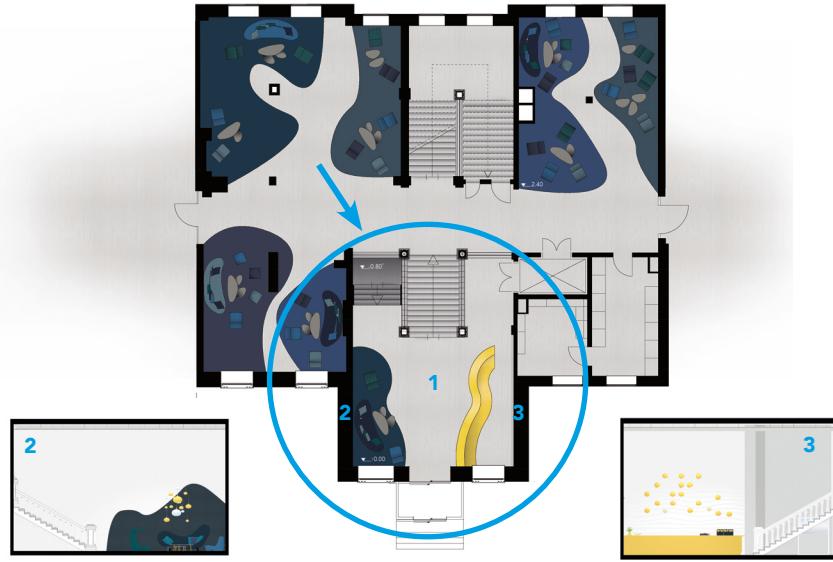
Wandabwicklungen mit Verortung im Grundriss
